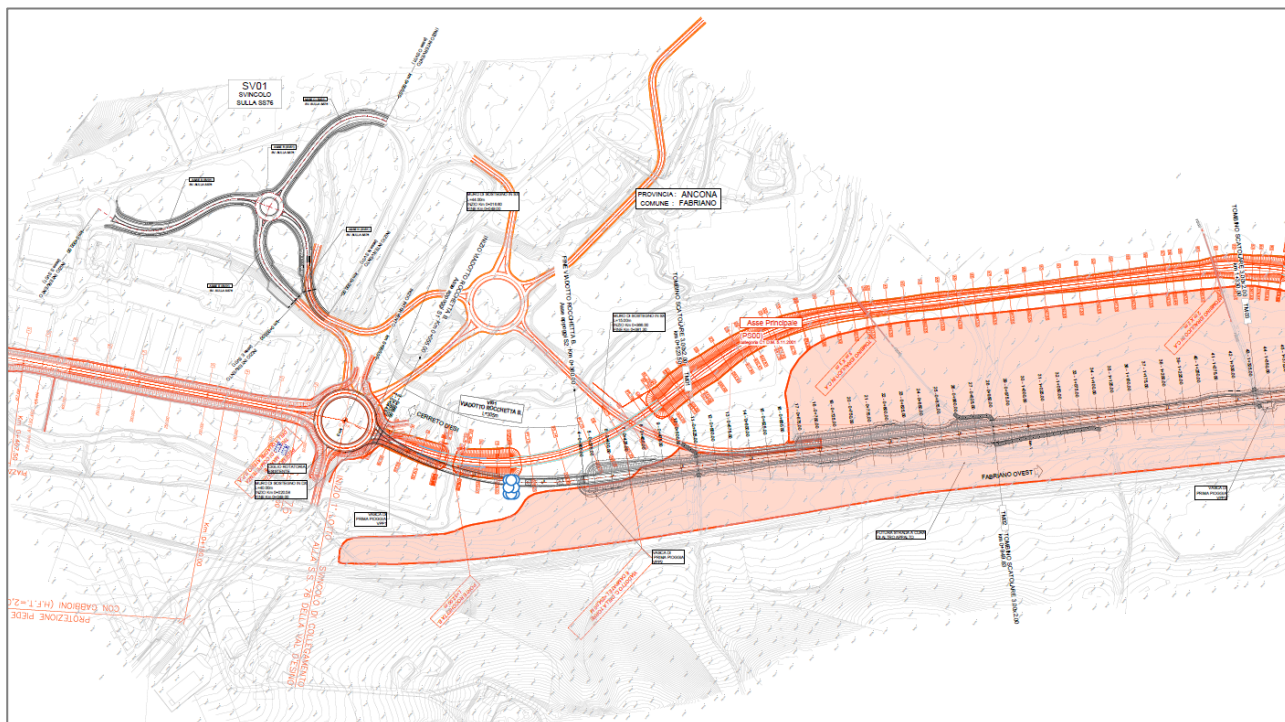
Planimetria di sovrapposizione del progetto definitivo al progetto preliminare - Tav. 1/3. Legenda: Progetto definitivo 2023 in tratto nero; Progetto preliminare del 2012 in tratto di colore arancio; area logistica stralciata nel 2023 in retinato di colore arancio (Fonte: Allegato 4 alla Lista di Controllo)
